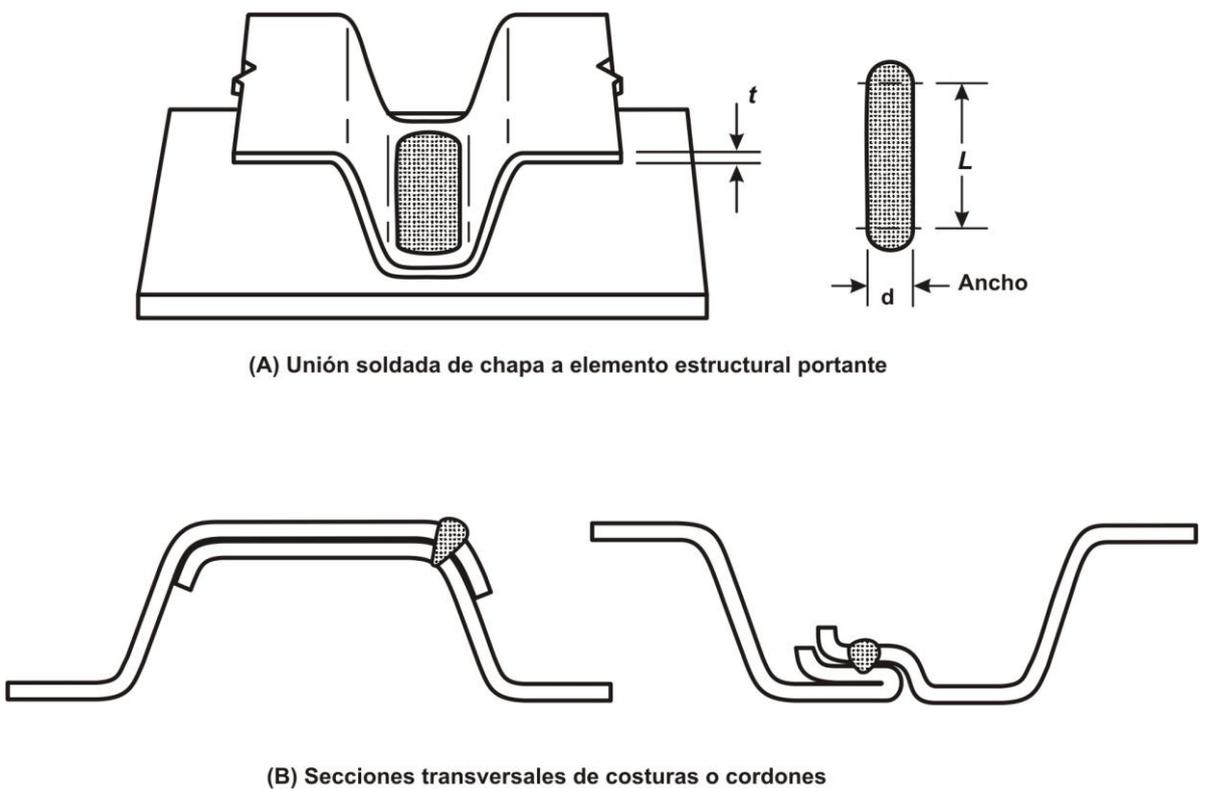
Soldaduras por arco tipo costura o cordón.
